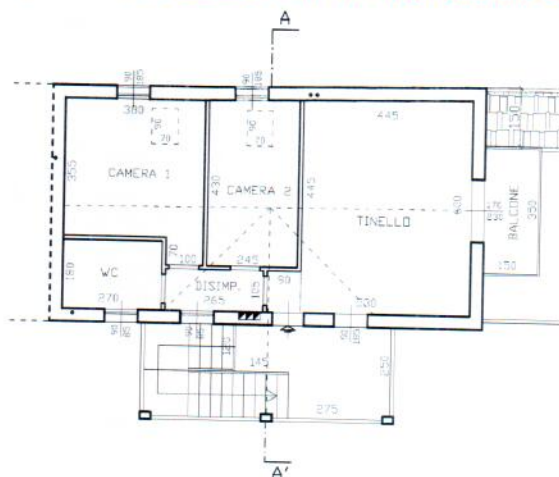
planimetria progetto Permesso costruire del 03/03/2008 prot.n. 0006630
